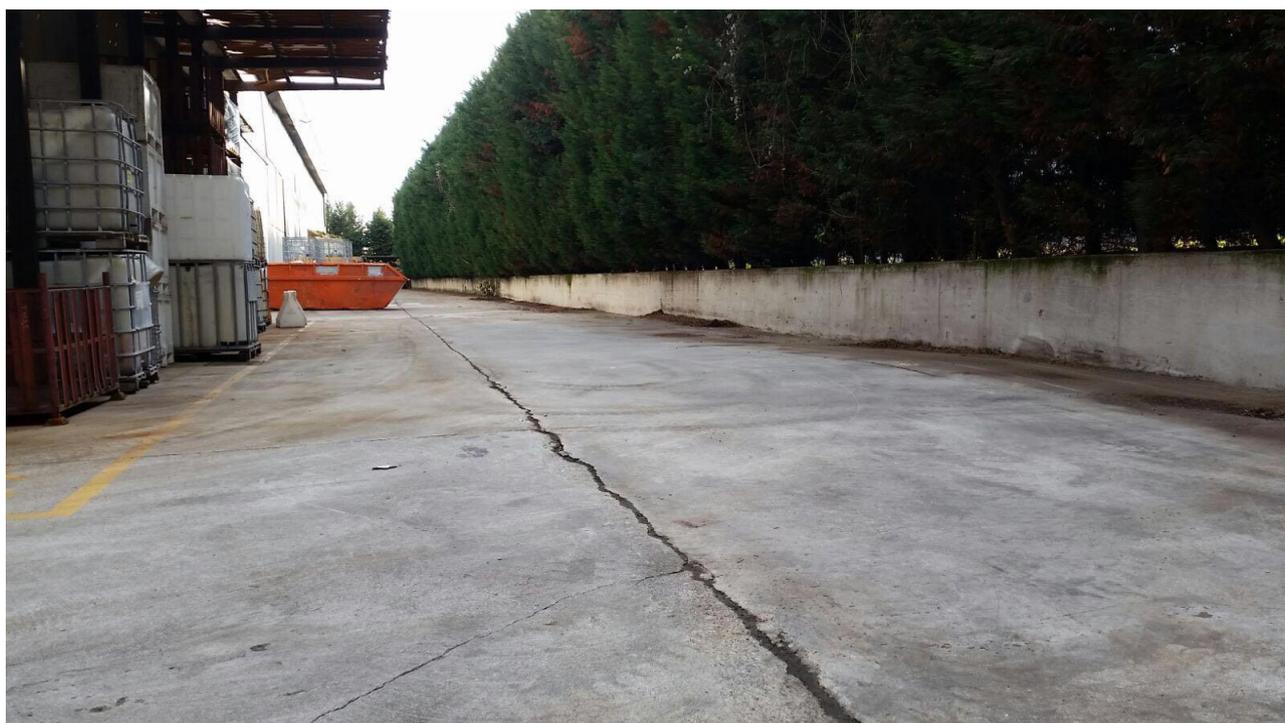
Muretto in sponda sinistra Rio Rodegotto a protezione dello stabilimento
